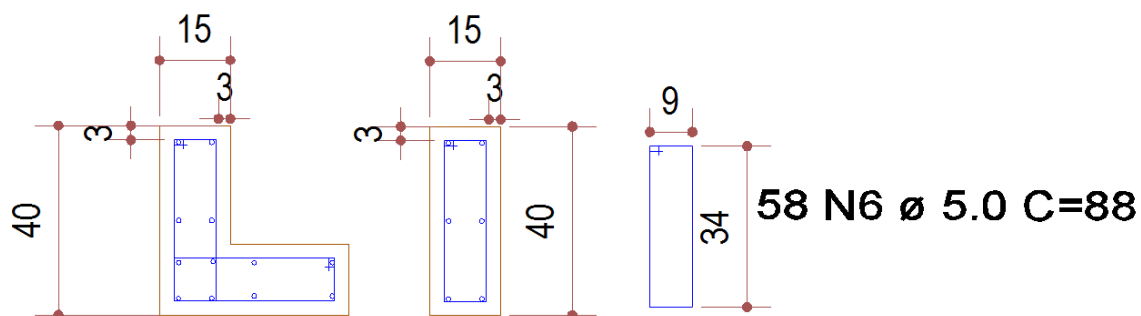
Armaduras Longitudinais e Transversais Pilar 2
